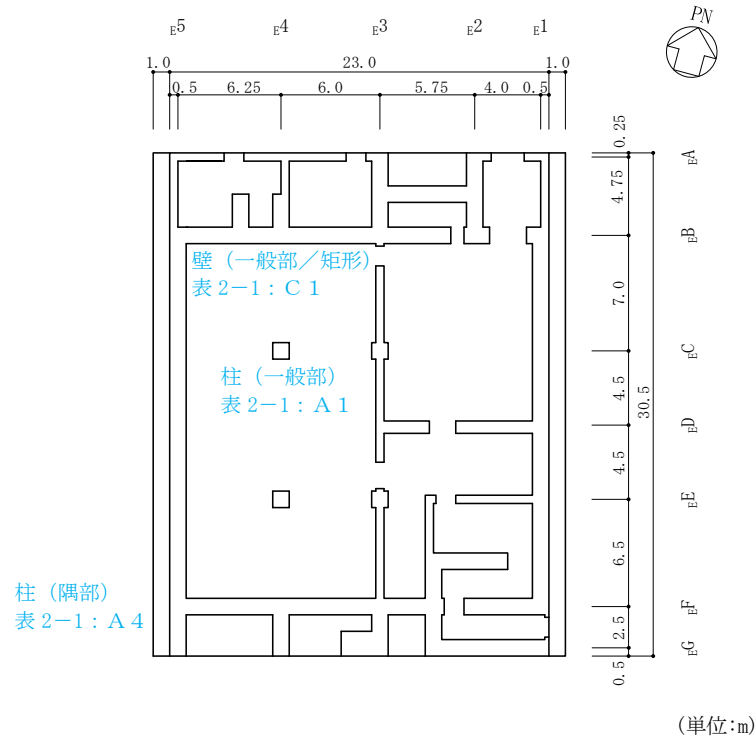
緊急時対策所の概略平面図 (EL 50.25m)
